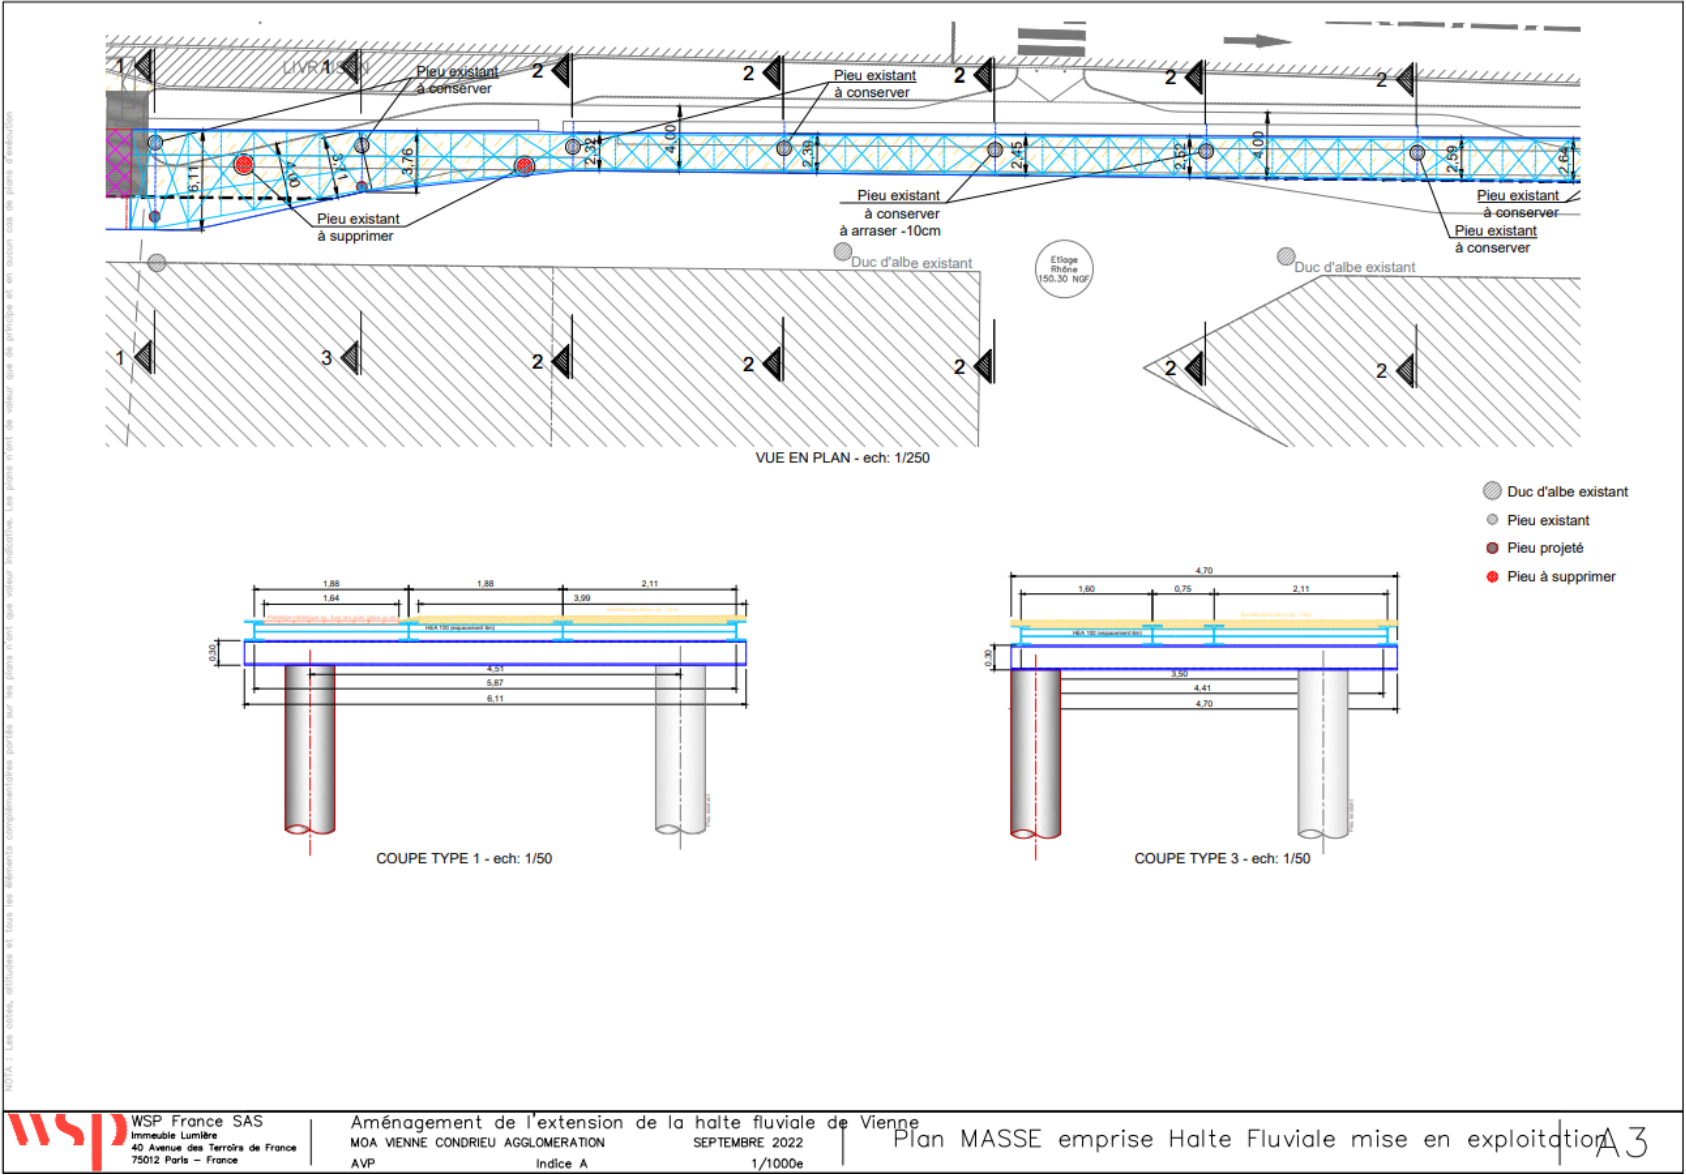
Plan masse et coupes emprise halte fluviale (3)
